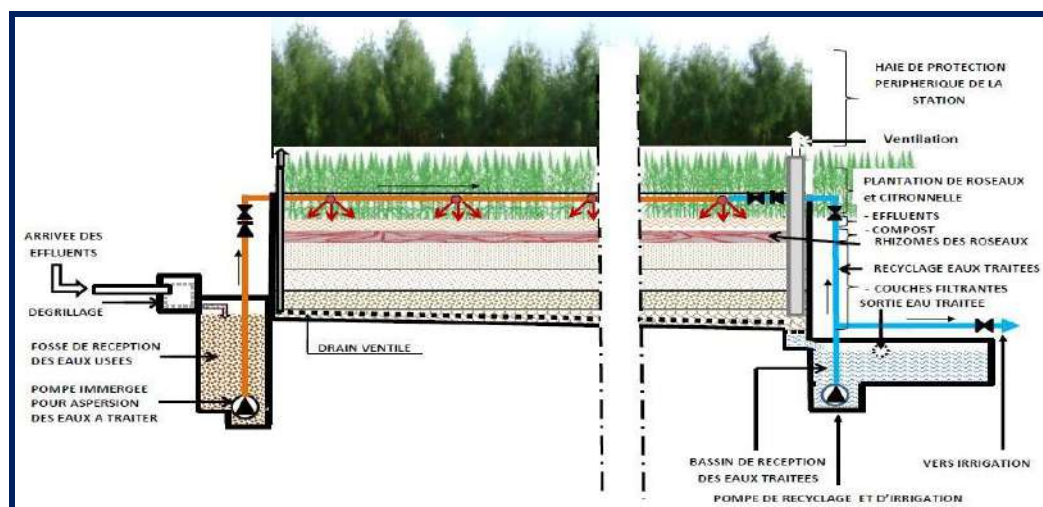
Coupe longitudinale des filtres à écoulement vertical.
